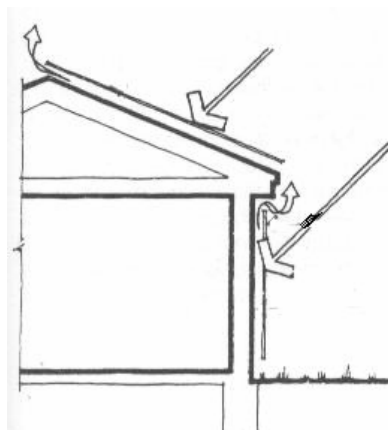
Fachada ventilada propuesta para toda la casa. (Fuente: casasconfortables.net)
